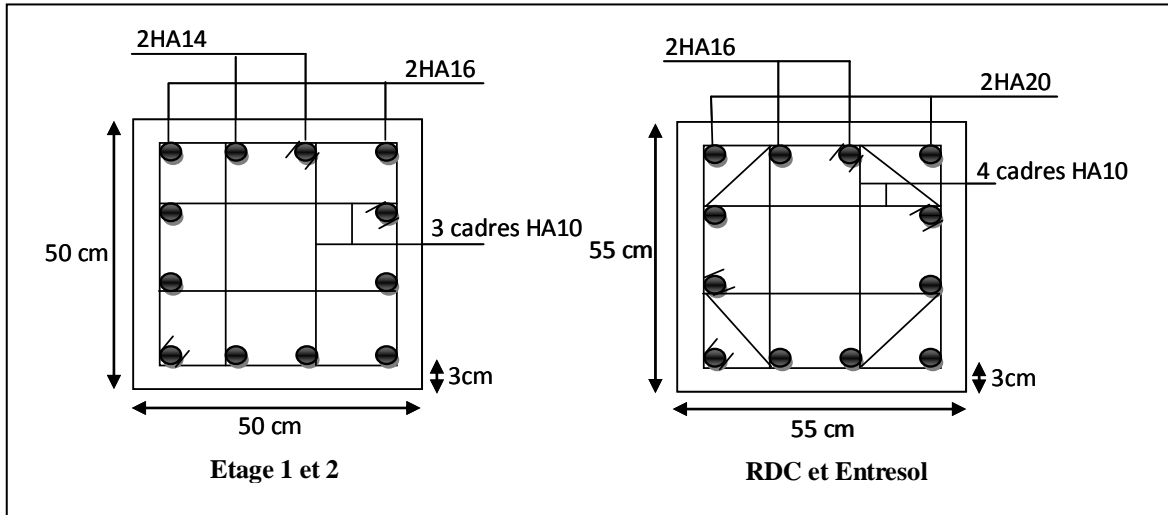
Schéma de ferrailage des poteaux du RDC, E. Sol et des étages 1 et 2
